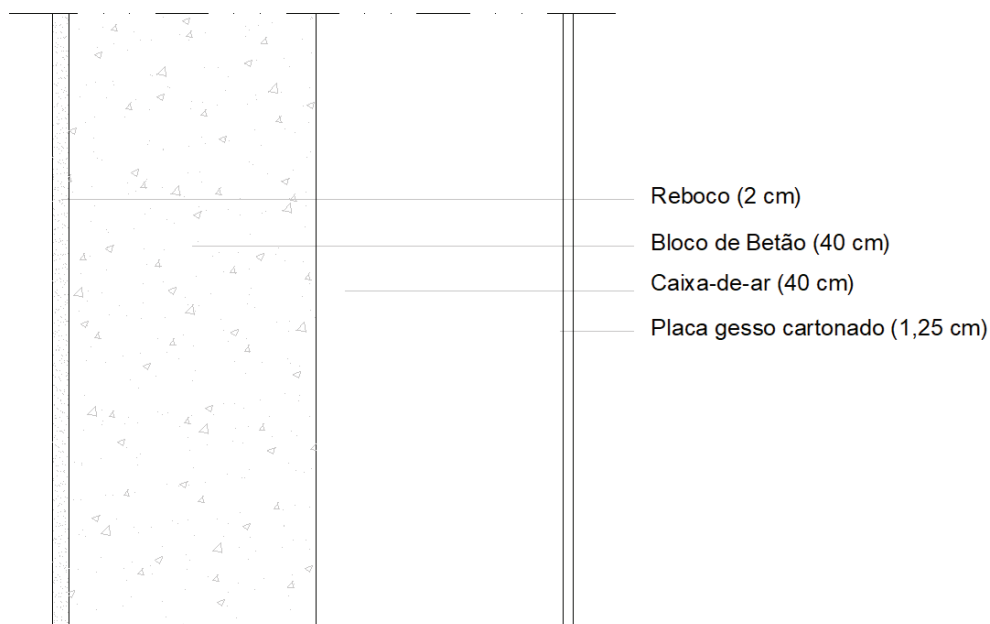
Pormenor construtivo da parede interior tipo XIX (circulação)
